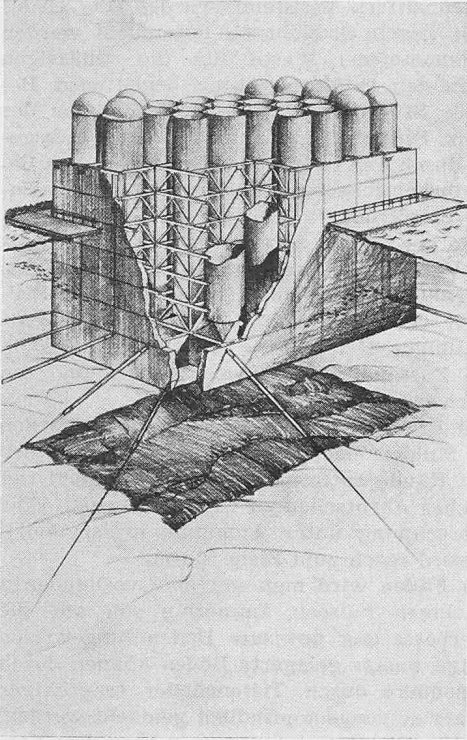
Tajobrücke, Pfeilergründung: Stahlcaisson eingeschwemmt und verankert
